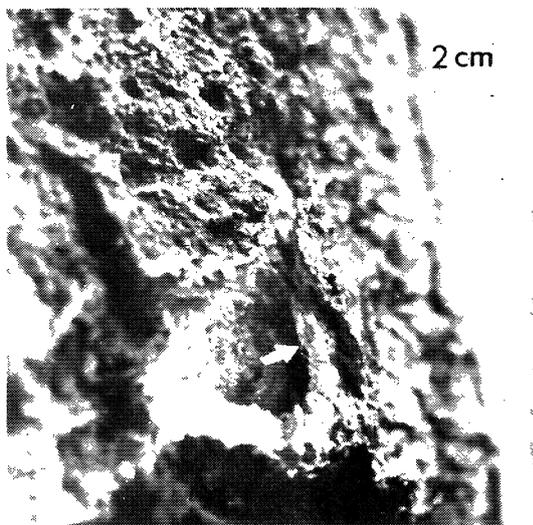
Detalle de una costra sobre la piedra de Laspra.
